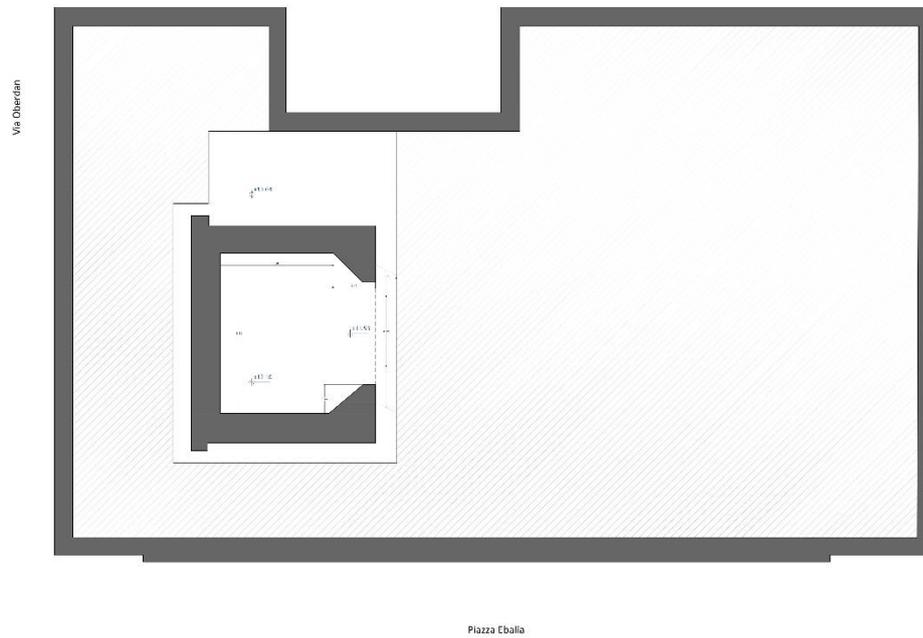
Pianta piano interrato. Rilievo architettonico a cura dell'Ing. Giorgio Tonti.
